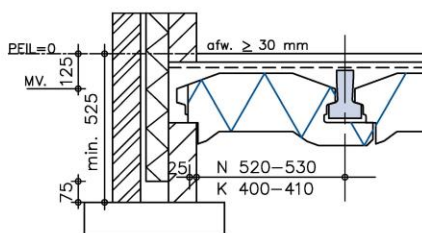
DETAIL - EINDOPLEGGING ZONDER RANDKIST
